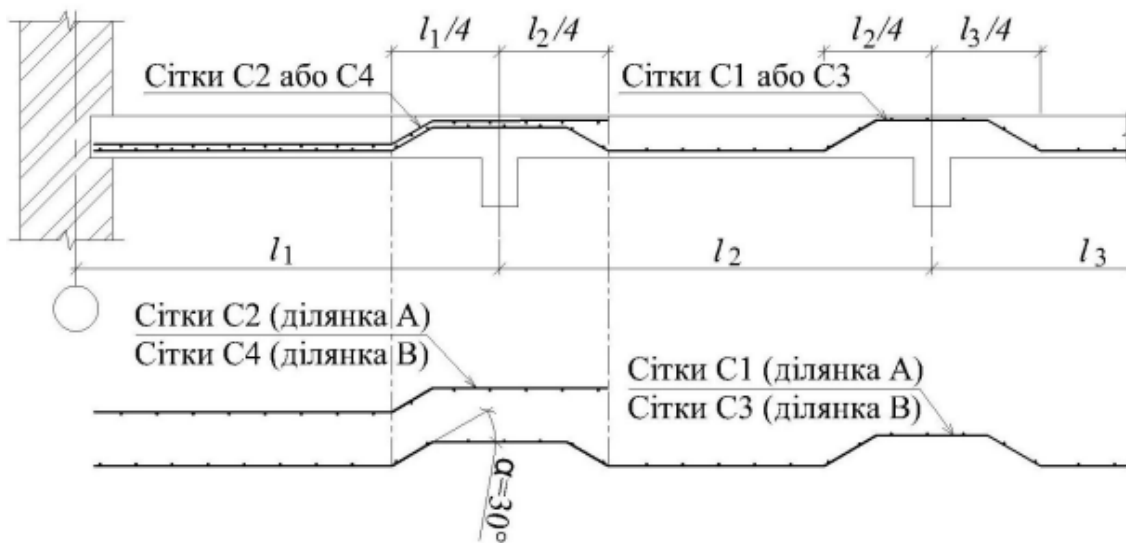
Армування плити рулонними зварними сітками з поздовжньою робочою арматурою
